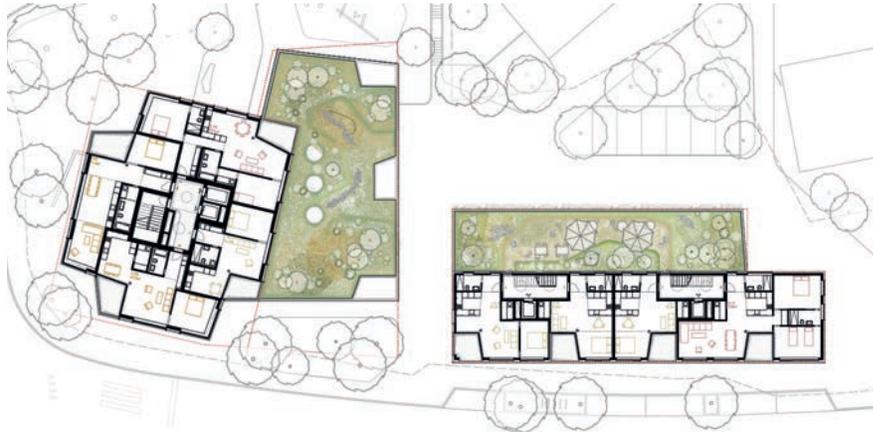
7. bis 13. Obergeschoss und Attikageschoss
